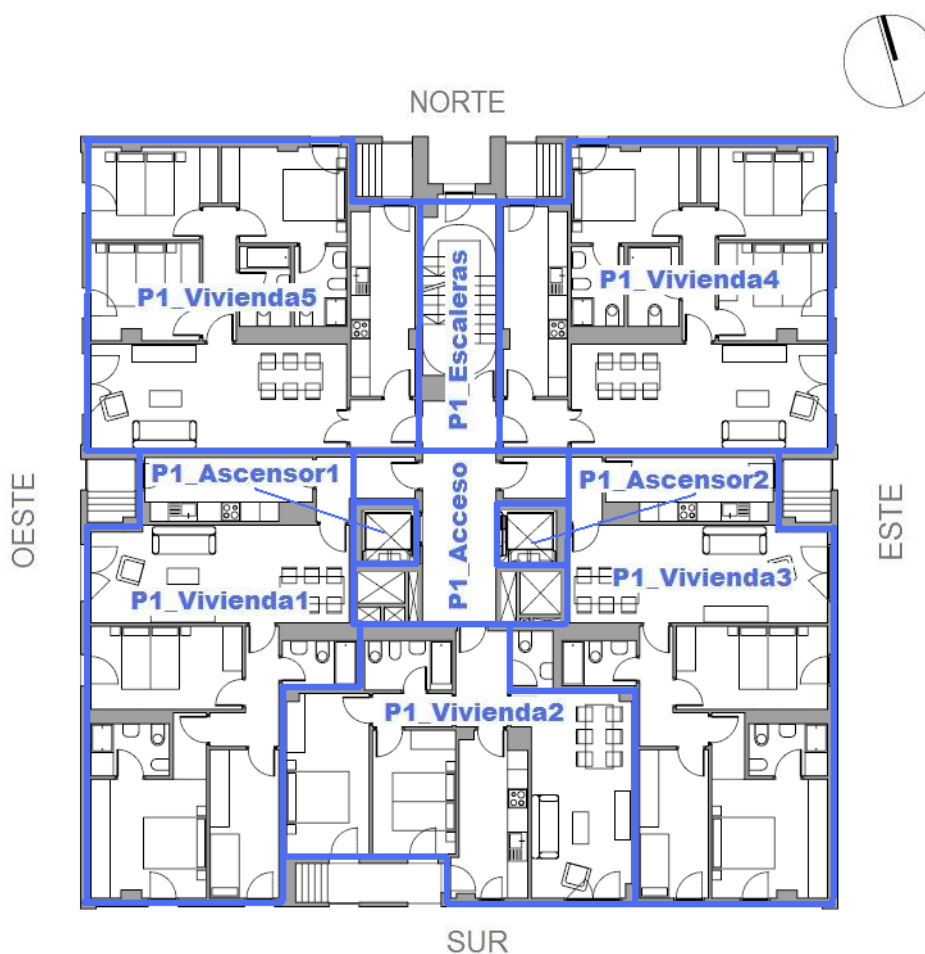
Plantas primera a octava. Edificio de viviendas de Ripagaina.
